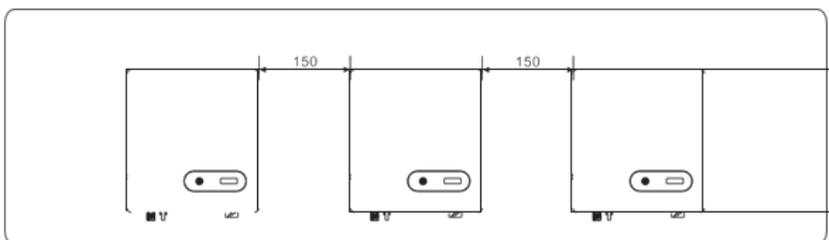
Installazione lungo la stessa linea (unit: mm)
